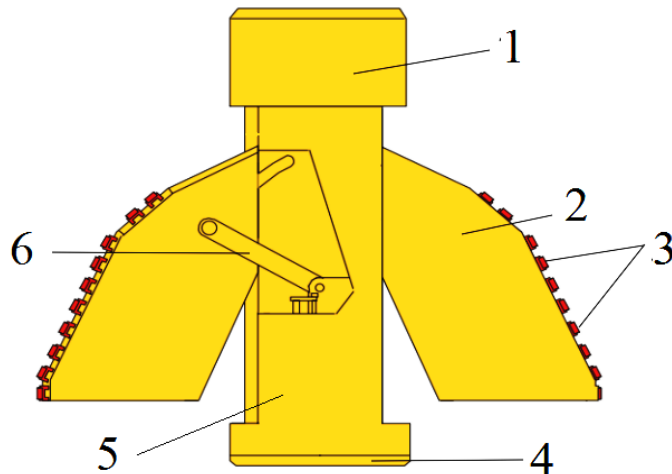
Розширювач нижньої частини свердловини: 1 – корпус; 2 – ріжучий кронштейн; 3 – різці; 4 – обертове відкидне дно; 5 – бункер для розбуреного ґрунту; 6 – підйомний важіль
